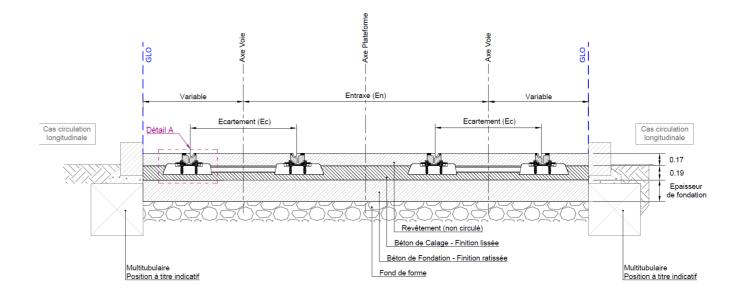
coupe type d'une plateforme - Voie béton traverses – Revêtement minéral circulé carrefour
